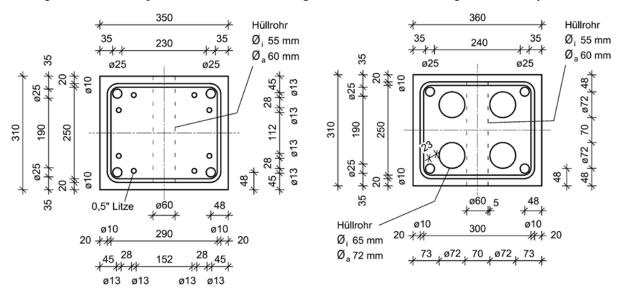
Querschnitte Obergurt links und Untergurt rechts (Maße in mm) (Biadatz 2017) Im Ober- und Untergurt wird eine Längsbewehrung mit 4 Stäben Ø25, welche die Mindestbewehrung abdeckt und eine Bügelbewehrung von Ø10/30cm gewählt. Die Bügelbewehrung wird auf die maximale Querkraft von 43,3 kN im GZT 1 (Bereich Untergurt A-B) bemessen. Grundsätzlich wäre eine Anpassung des Obergurtquerschnittes auf eine Breite von ebenfalls 36 cm möglich um eine einheitliche Schalung zu verwenden (Abb. FA.21). Dies würde eine zu vernachlässigende Zunahme des Eigengewichts von 4,7 kN für den gesamten Träger bedeuten. Da die Gurte als Fertigteile nicht über die gesamte Trägerlänge hergestellt werden können, müssen diese gestoßen werden. Um eine aufwändige Kopplung dieser Stöße zu umgehen wird die Kombination aus Vorspannung mit Verbund und Vorspannung ohne Verbund durch eine reine Vorspannung ohne Verbund ersetzt (Abb. FA.21). Die Vorspannung erfolgt mit 4 Hüllrohren Ø72 mm in denen je 5 Monolitzen Ø15,7 mm (Z-13.72-30036) vorgesehen werden.
